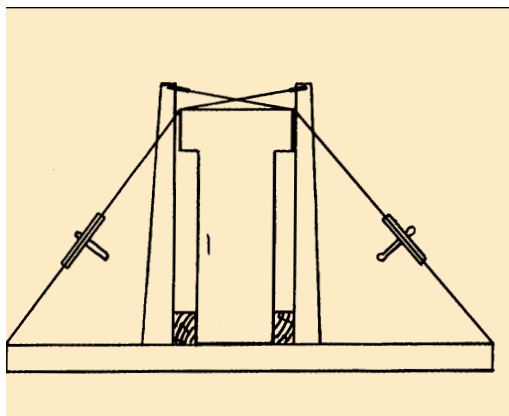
Chargement de plusieurs poutres en béton précontraint.
